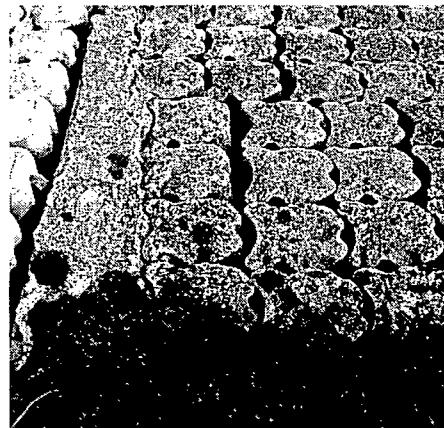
open zetting tussen betonzuilen (dijkpaal 226)
